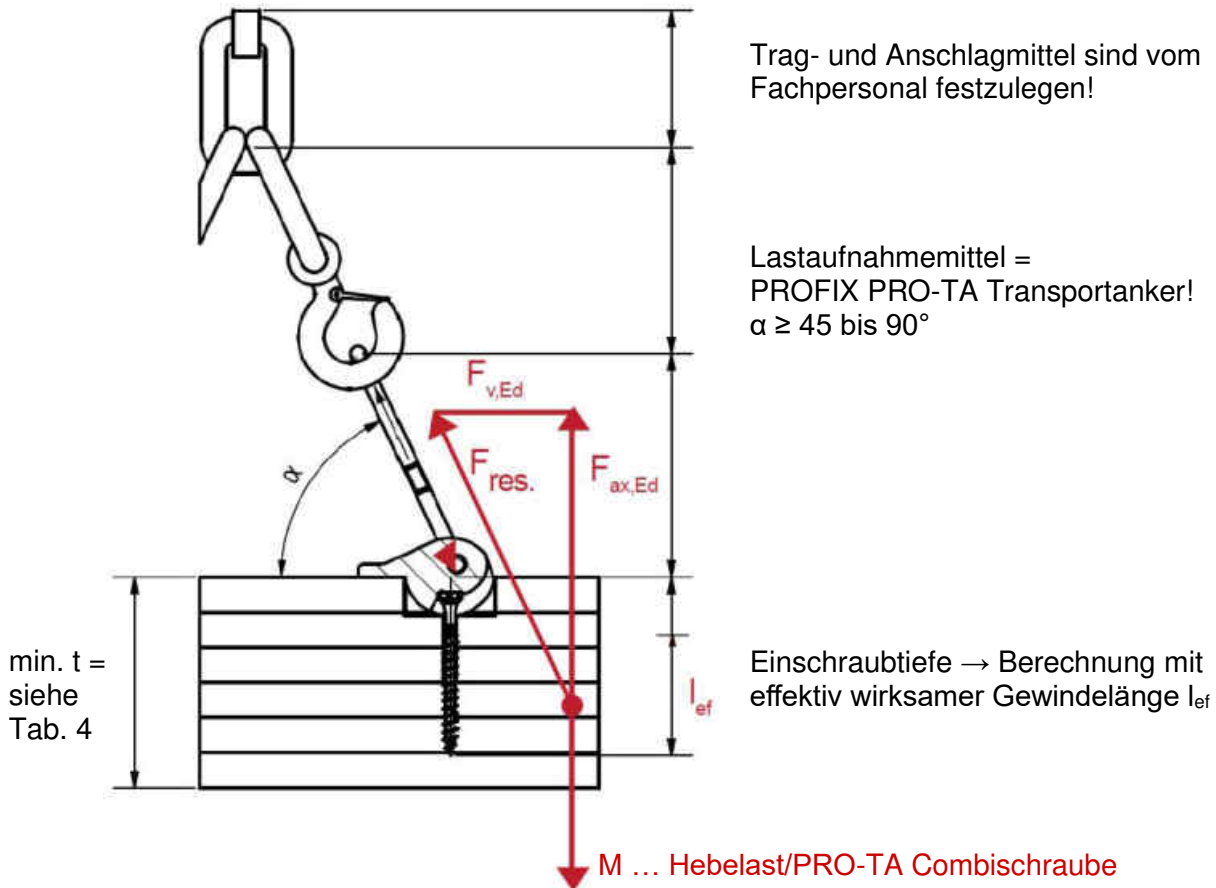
Axiale Beanspruchung bei eingefrästem PROFIX PRO-TA Transportanker
